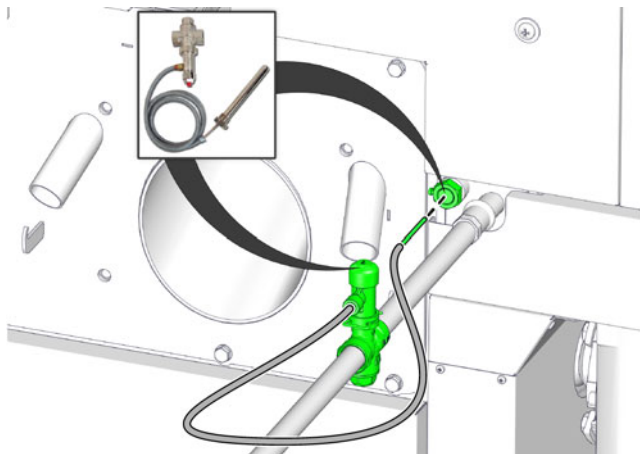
Tube capillaire du dispositif de soupape thermique
